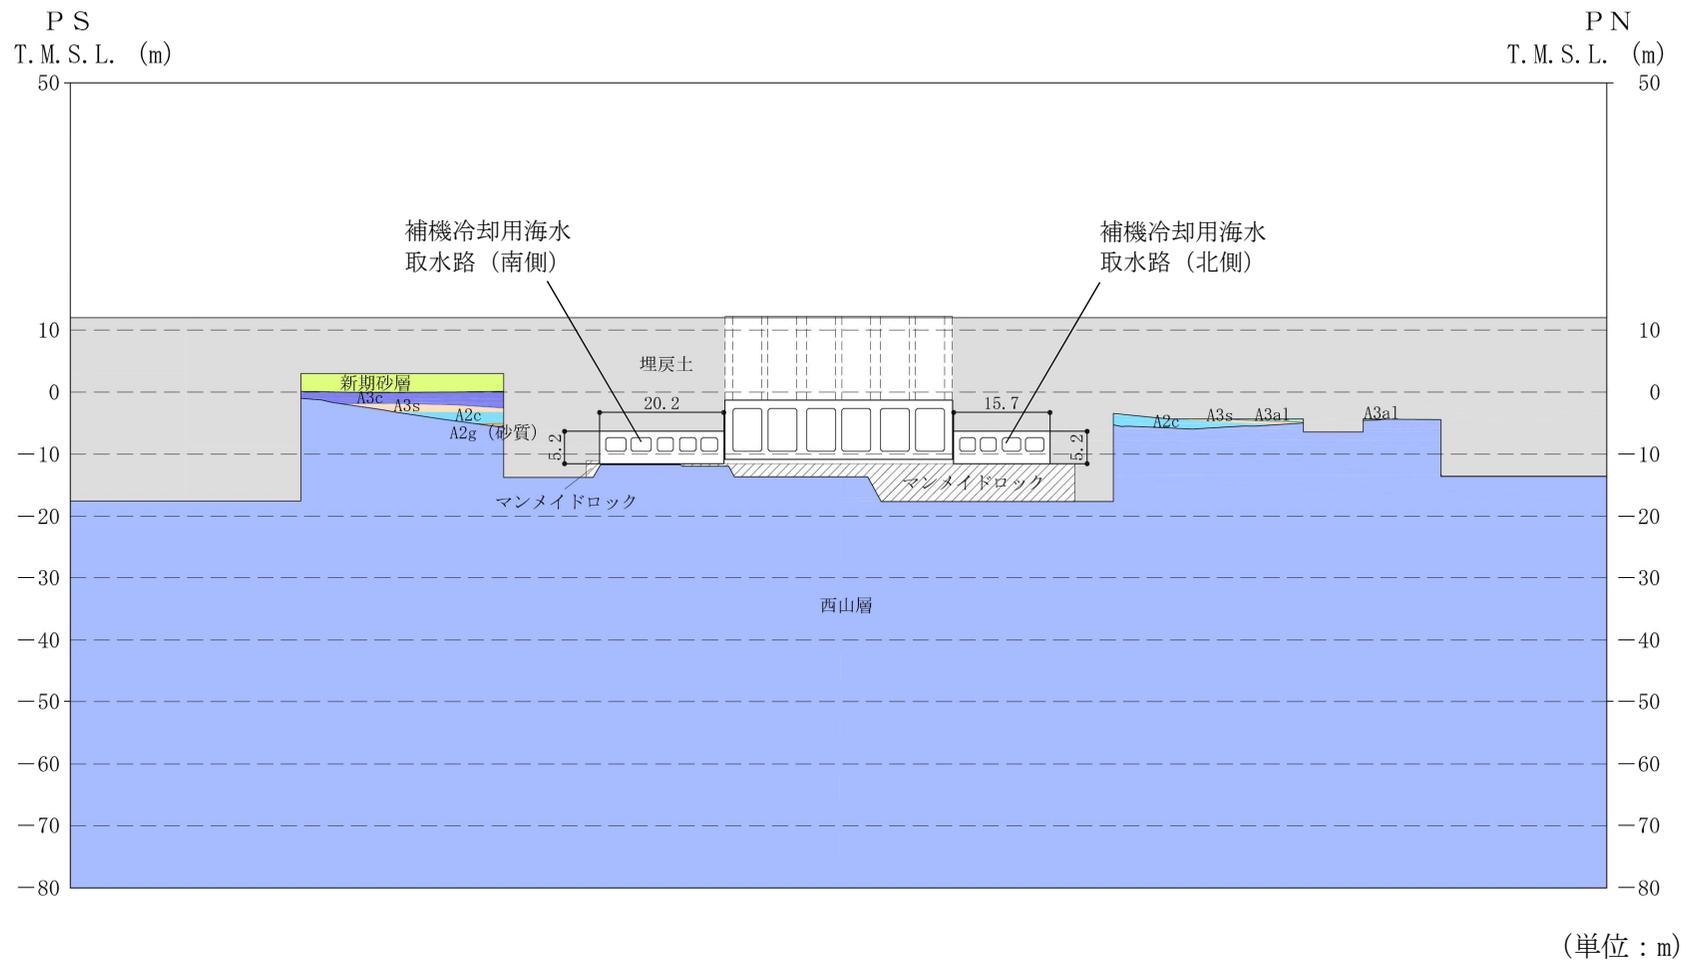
補機冷却用海水取水路の周辺地質断面図 (A-A断面)
